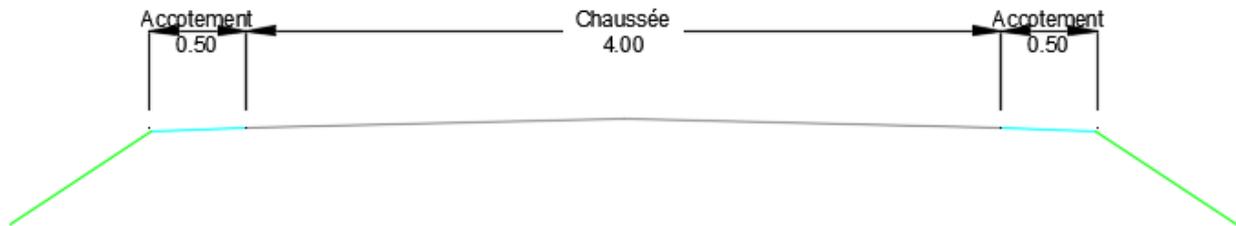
Profil en travers type pour les accès neufs (sur les emprises du chantier).
